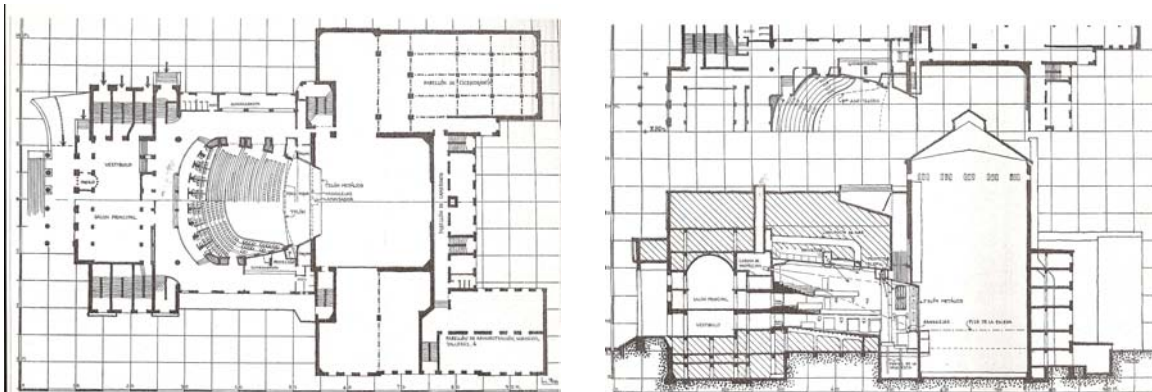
e 34 – Planta e Corte do teatro de Duisburg
